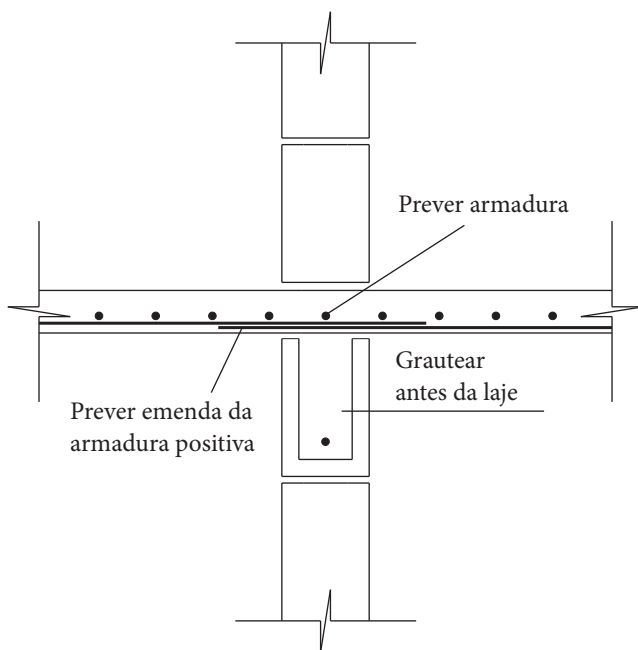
Detalhe da armadura de laje maciça sobre apoios.
